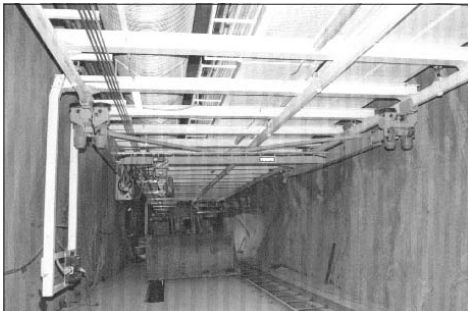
Unterhalb der aufgehängten Plattform: Umschlagbereich mit Kran [12]
